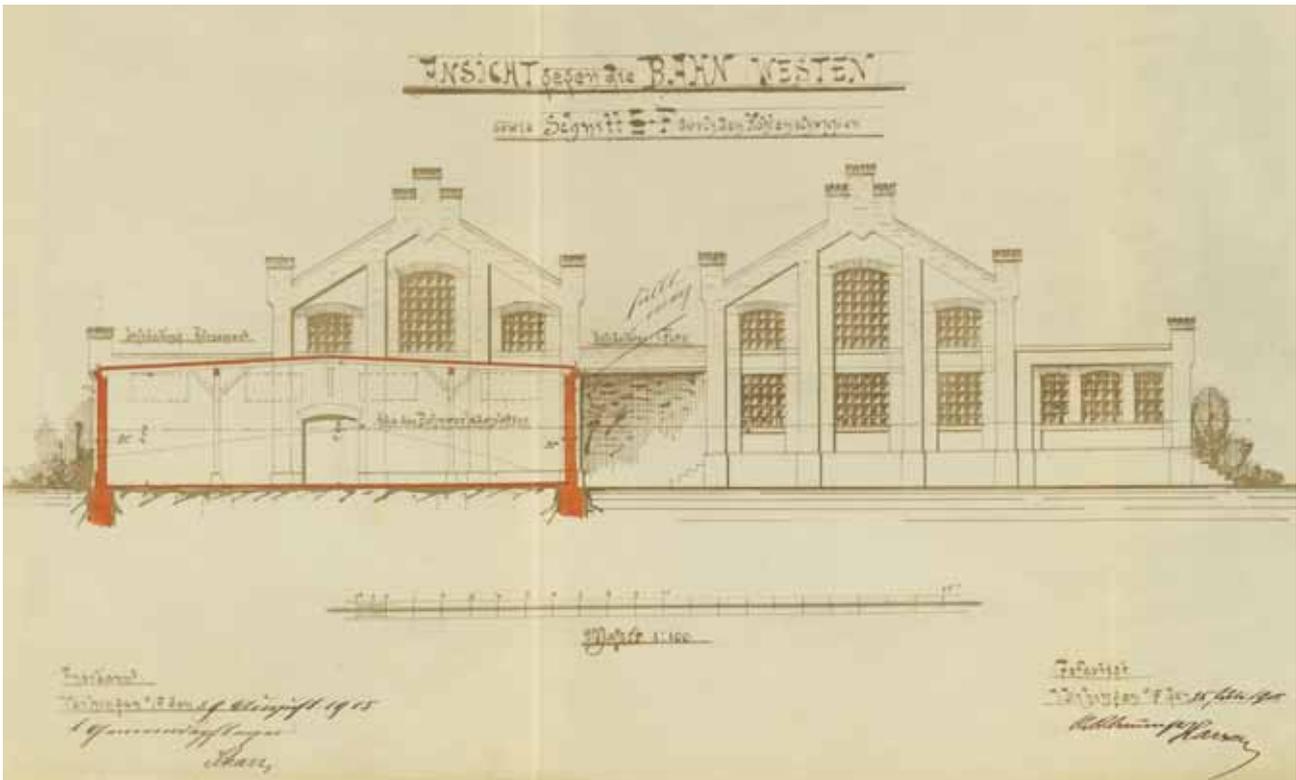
Bauantrag von 1905: Bauplan der Fassade des Gaswerks Vaihingen.
